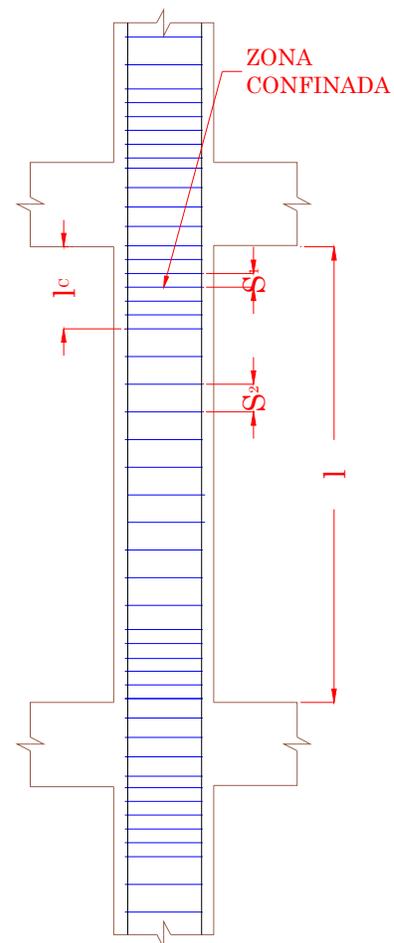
Requisitos de Refuerzo para Columnas de Marcos de Concreto
